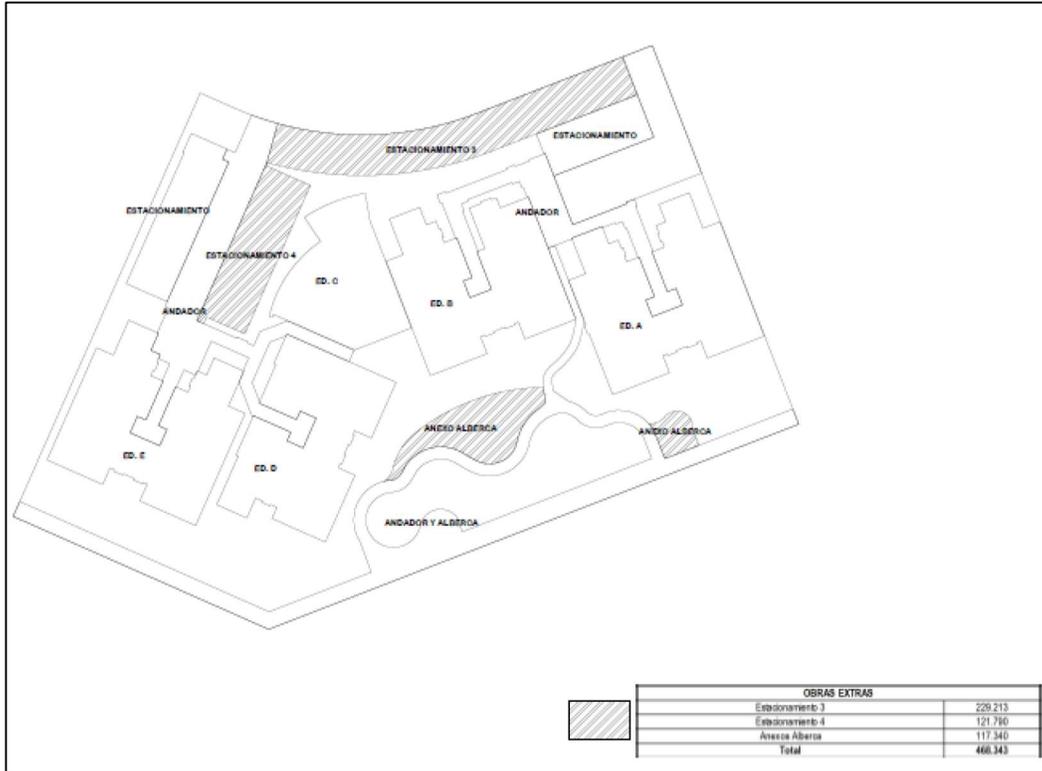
Obras que se pretenden construir dentro del proyecto como un anexo a lo ya sancionado por PROFEPA.
